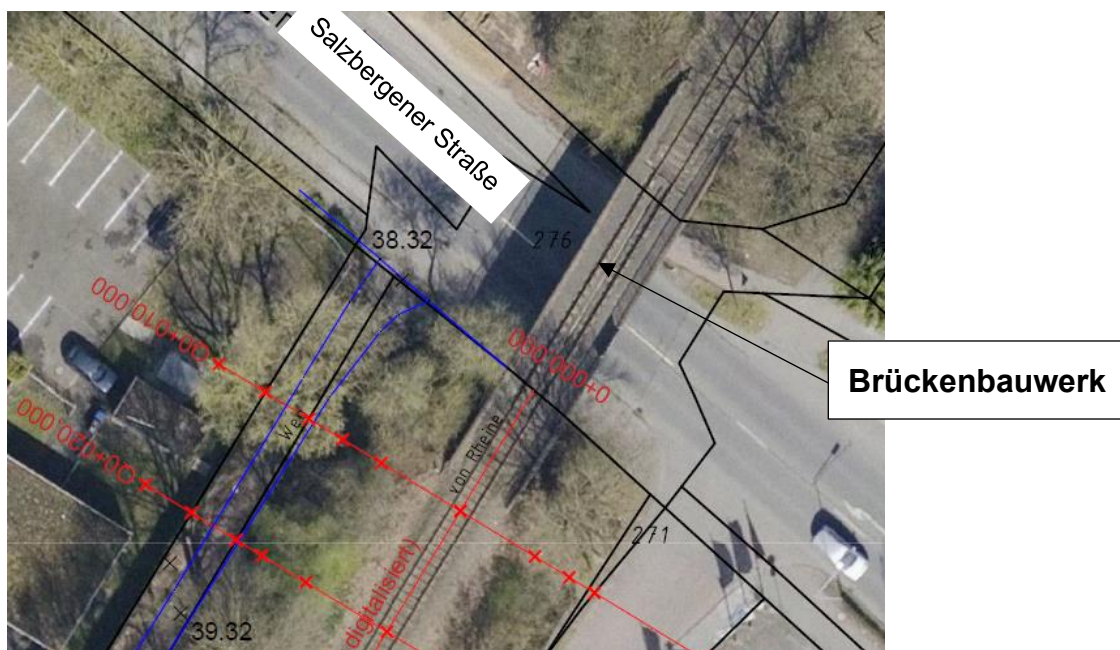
Orthofoto mit dem Brückenbauwerk über die Salzbergener Straße
